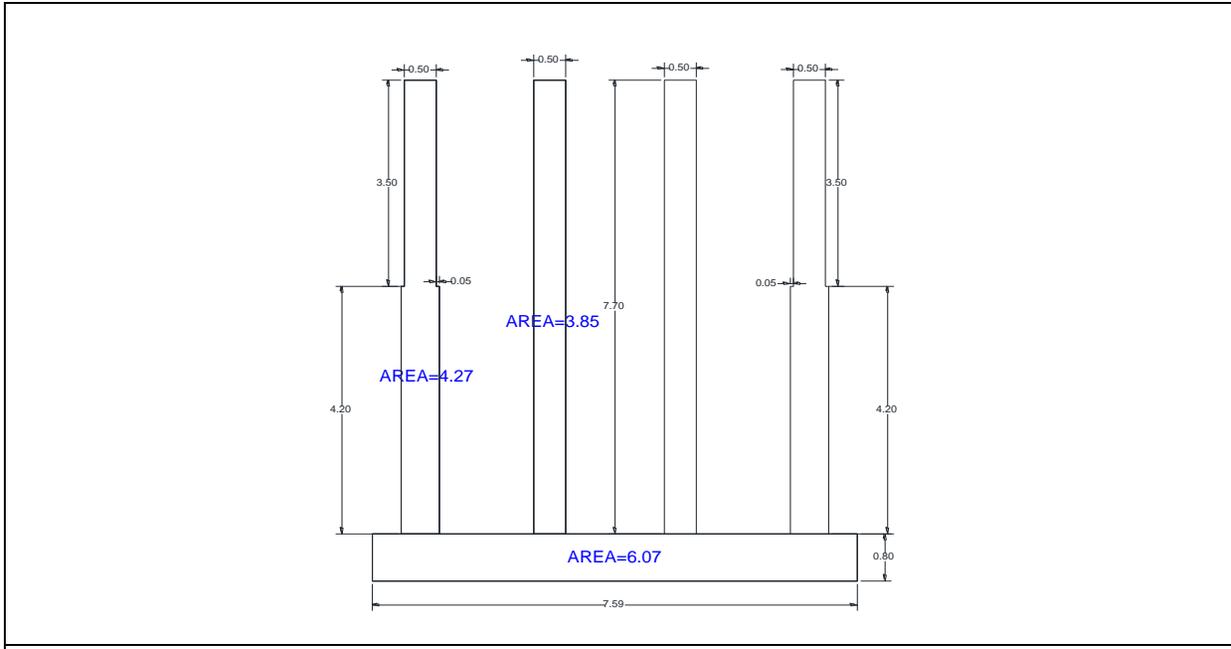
Se aprecian las pilas que se colaran con concreto.
